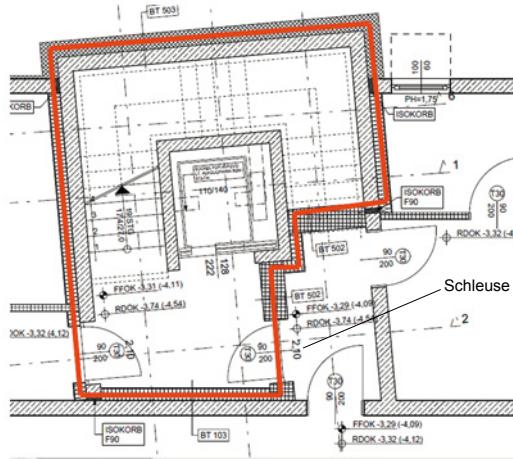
Grundriss durch warme Hülle im Treppenhausbereich [Architekt Kuzmich]
